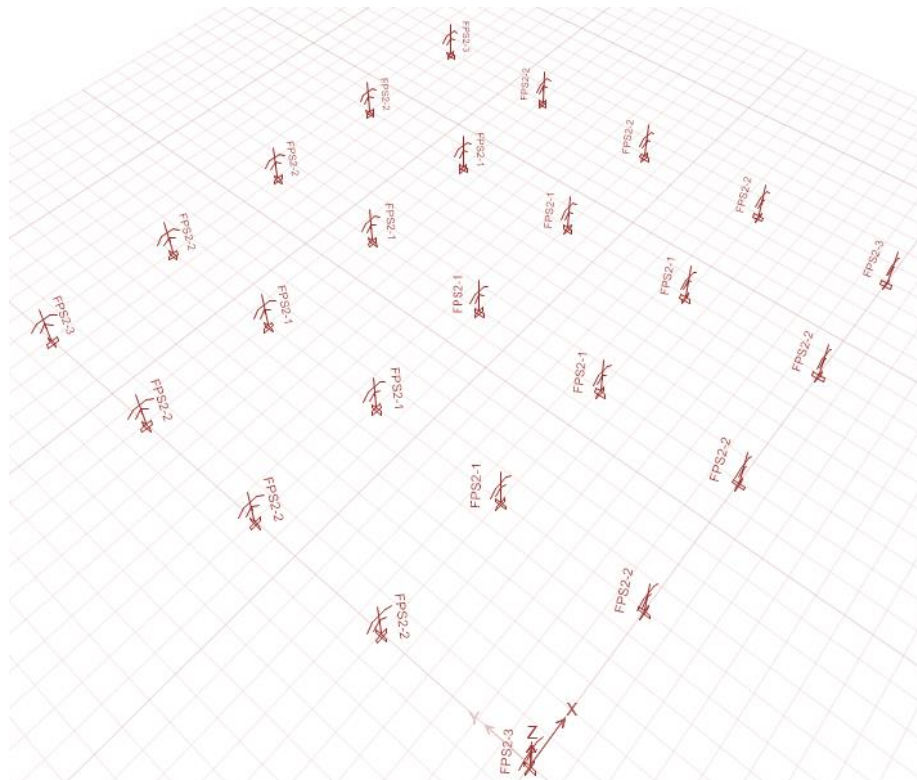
Distribución en Planta Aisladores tipo DFP (Microzona Piedemonte C). Fuente: Propia.
